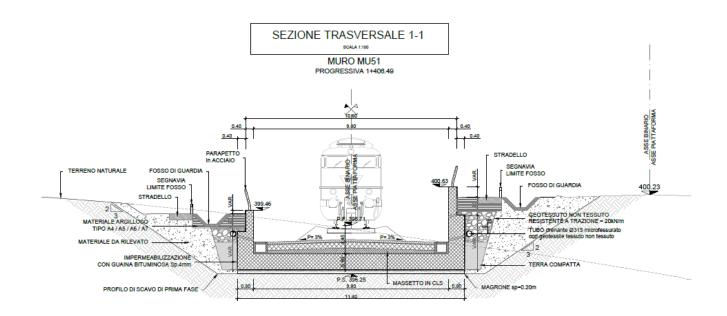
RI51: Muro a U MU51 – Sezione 1.
